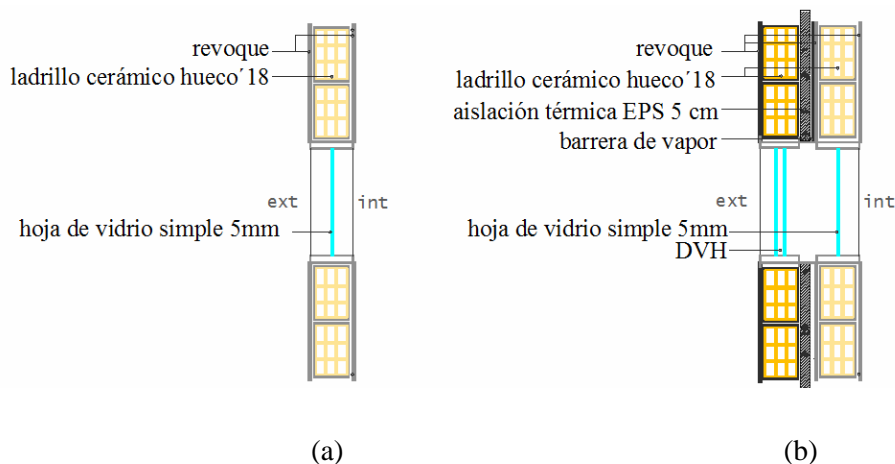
Detalle de muro y carpintería originales (a). Detalle de incorporación de muro exterior con aislamiento térmico y carpintería DVH (b).
